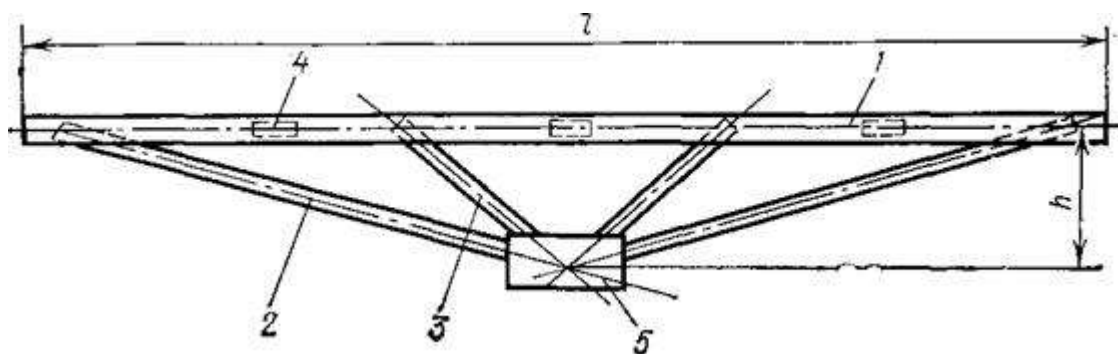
Схема типовой стропильной фермы, свариваемой точечной контактной сваркой
